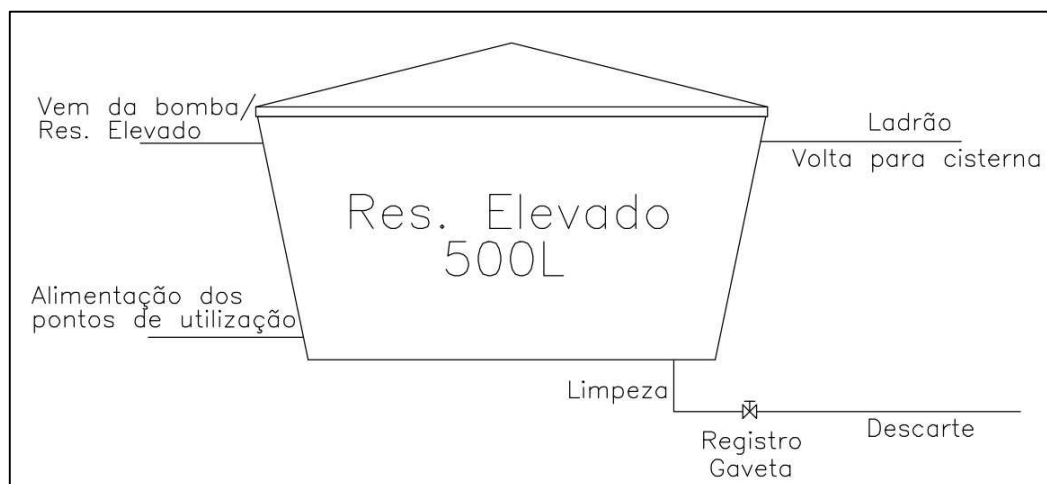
Detalhe esquemático das tubulações do Reservatório Elevado
